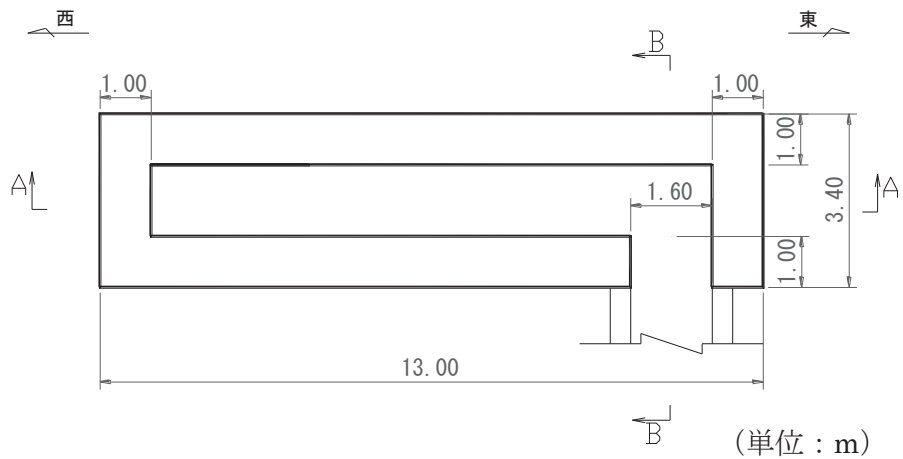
第 3 号機補機冷却海水系放水ピット平面図 (E-E 断面)
